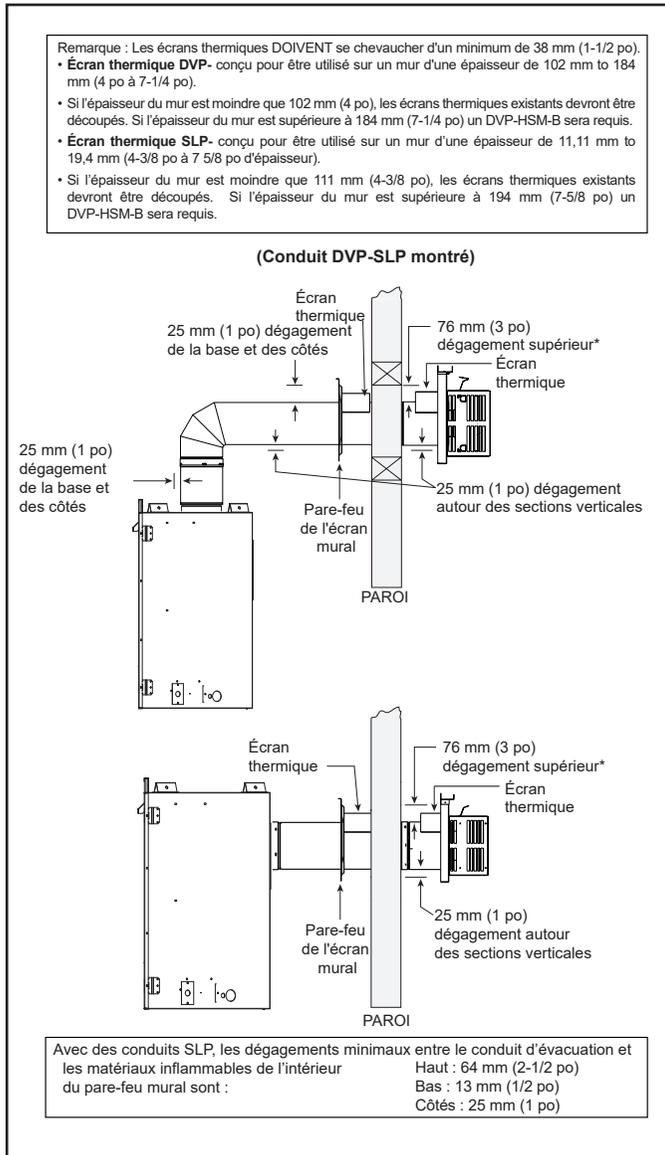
Dégagements des conduits horizontaux avec les matériaux inflammables
